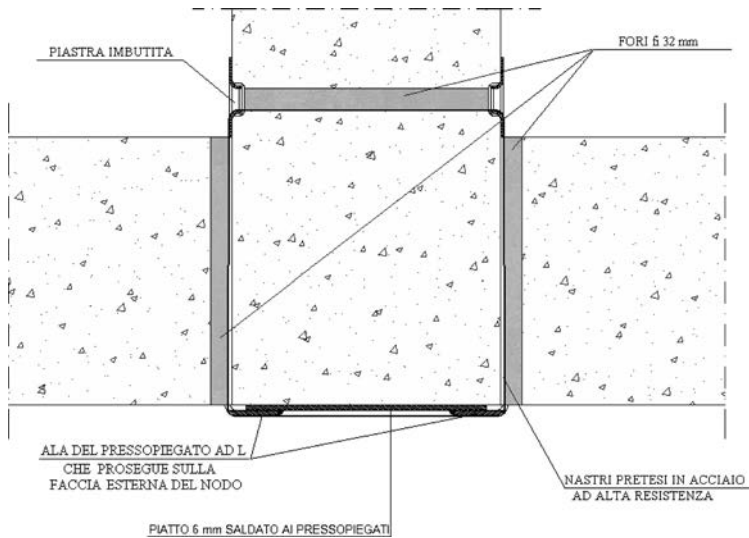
Vista in sezione all'altezza del nodo dello schema di cui alla Figura 3.12.
